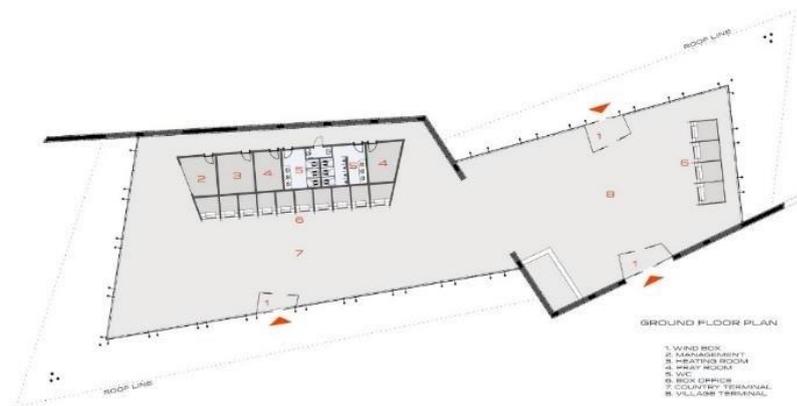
Planta baixa do terminal ônibus oeste de kayseri.
